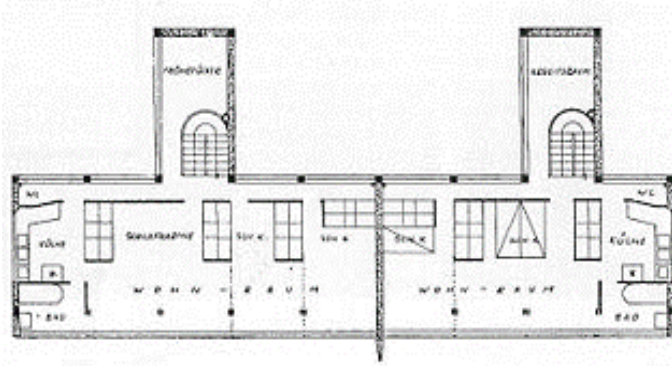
Le Corbusier, Planta tipo casas 14 y 15, Stuttgart, 1927
